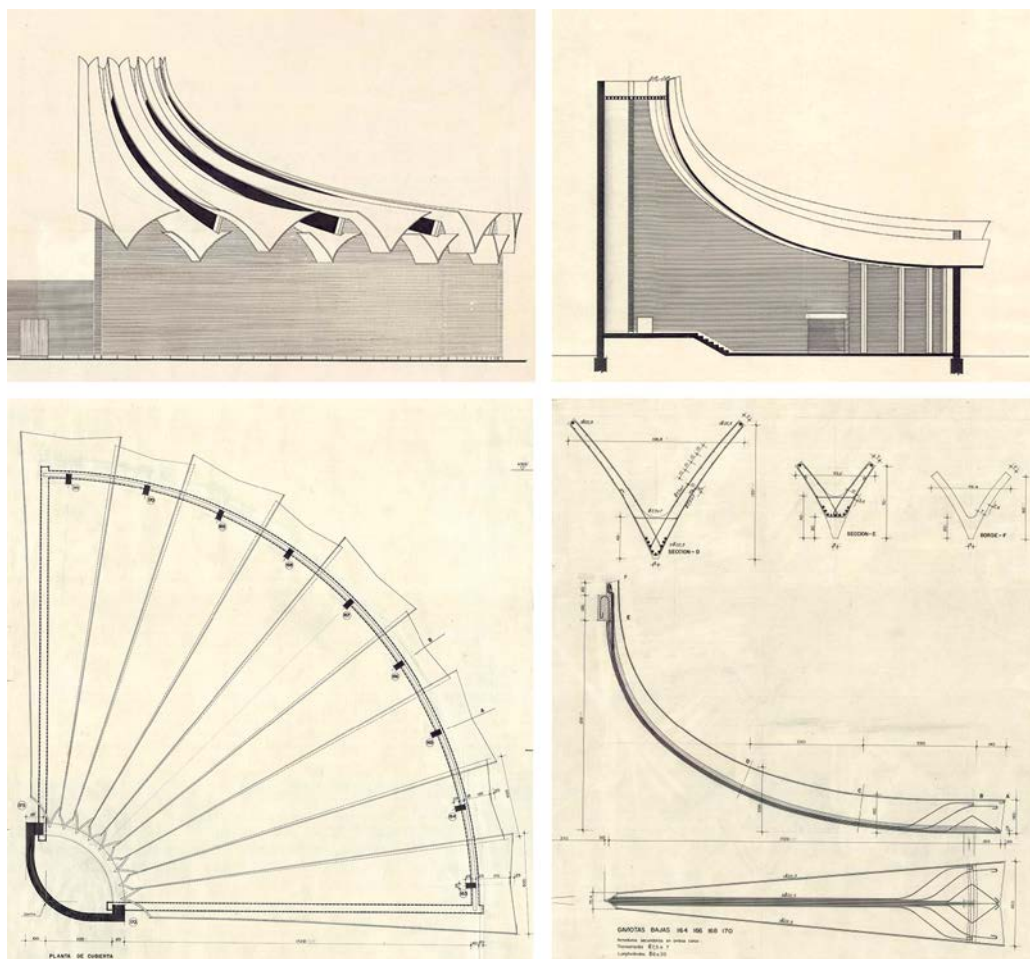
Planos de la iglesia (no ejecutada) Fachada, sección, planta de estructura y detalle de la "viga gaviota". (AFF, sig. 152).
